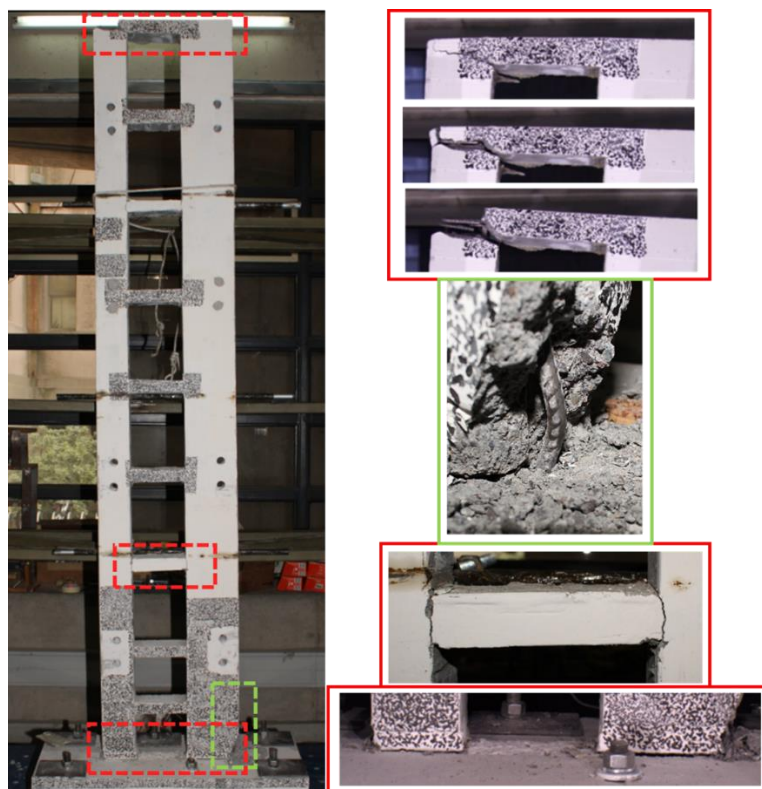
Detalle de fisuras en el último piso del muro para los últimos 3 niveles de desplazamiento de techo; pandeo de barra longitudinal; grietas de flexión en las uniones viga-muro; y grietas en la base – Probeta 3
